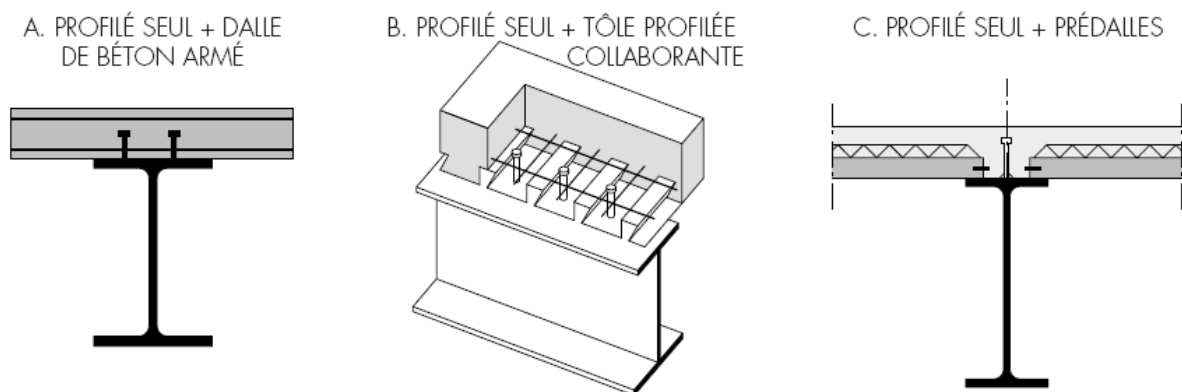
Exemples de poutres mixtes [12], [13]
